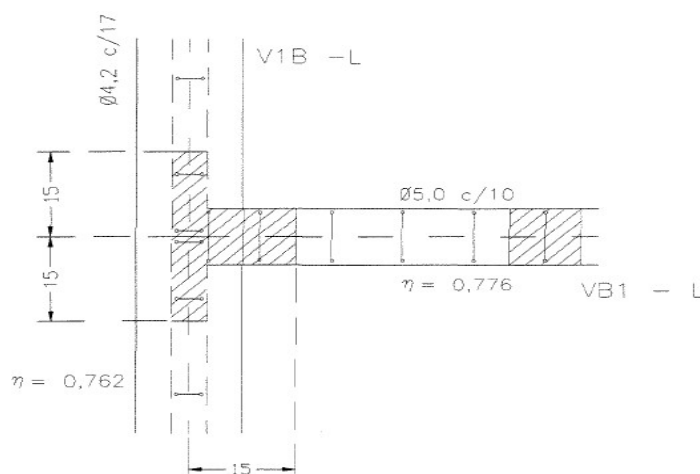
Esquema da aplicação das cargas nas vigas dos ensaios C1-R
